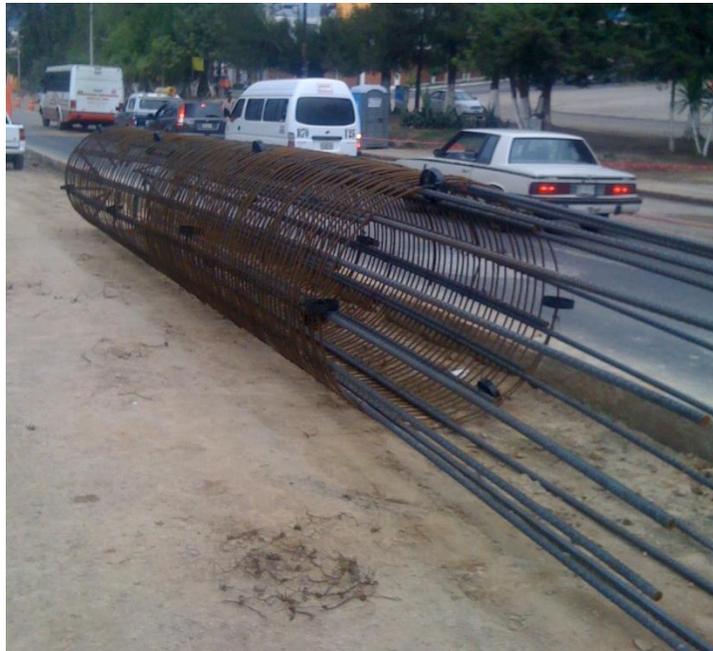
sección longitudinal del armado de la pila de cimentación. Fuente plano EST - VIA-GE-1130 DEL PROYECTO INTEGRAL VIADUCTO IGNACIO ZARAGOZA
